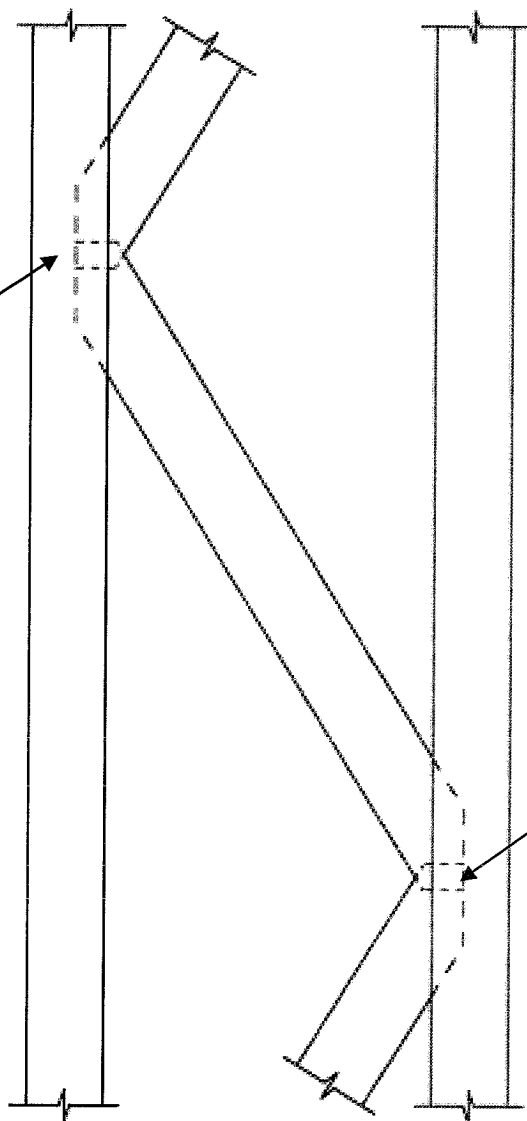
OPEN JOIST 2000 – HAUTEUR 406 mm
